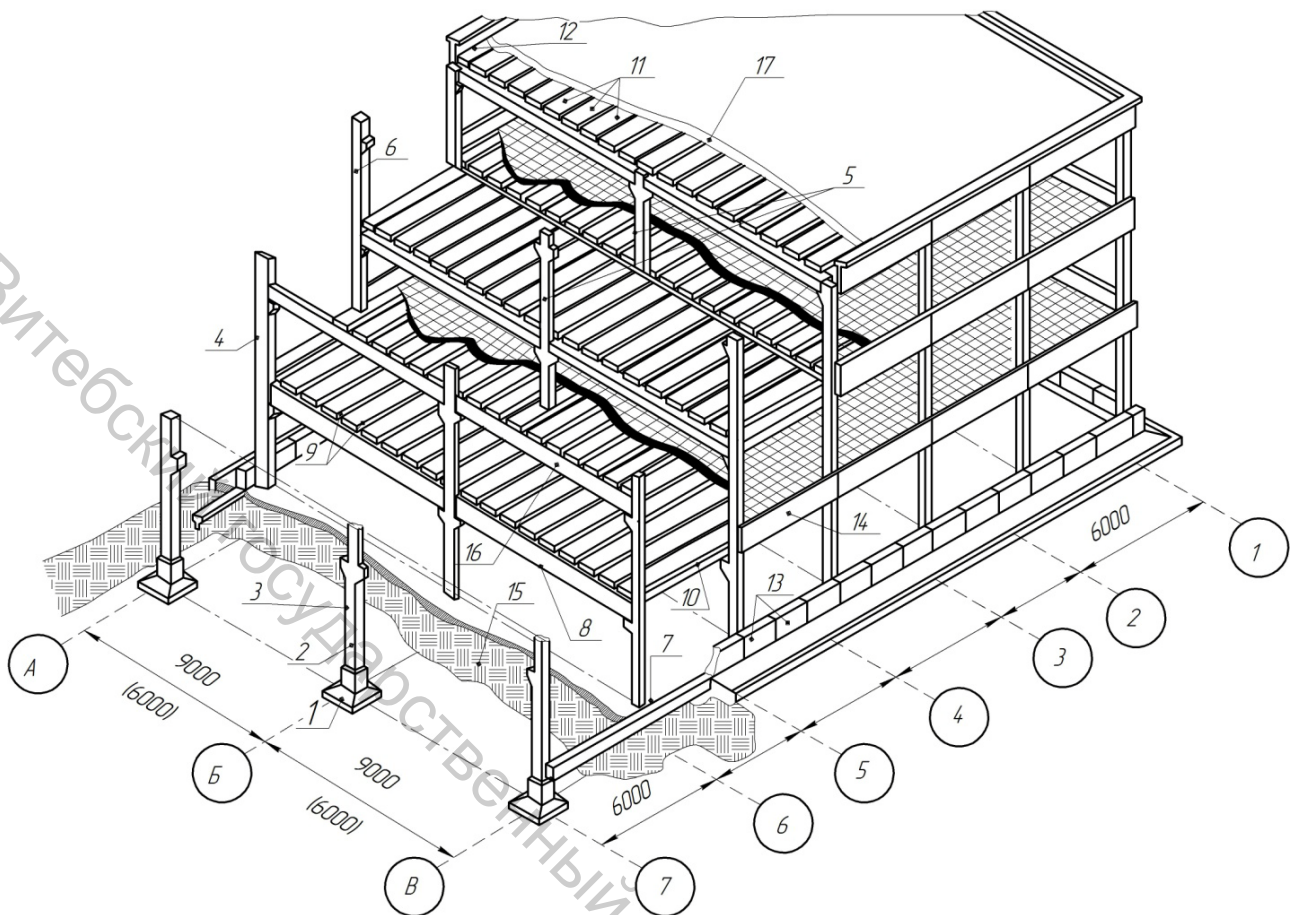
Многоэтажное производственное здание с балочными перекрытиями: 1 – фундаментальный железобетонный блок; 2 – коротыши железобетонной колонны; 3 – средняя колонна типового этажа; 4 – крайняя колонна типового этажа; 5 – средняя колонна верхнего этажа; 6 – крайняя колонна верхнего этажа; 7 – фундаментальная балка; 8 – ригель междуэтажного перекрытия; 9 – типовые железобетонные плиты перекрытия; 10 – доборная плита перекрытия; 11 – типовые плиты покрытия; 12 – доборная плита покрытия; 13 – цокольные сборные балки; 14 – стеновая панель; 15 – пол первого этажа; 16 – пол типового этажа; 17 – кровля здания
